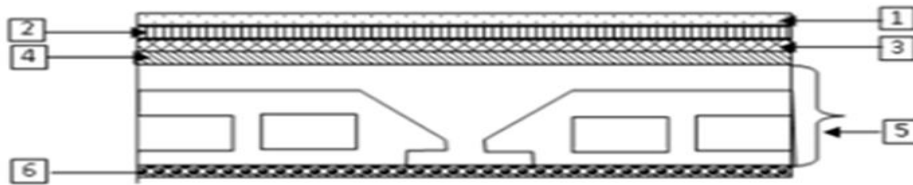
Coupe transversale d'un plancher terrasse inaccessible
